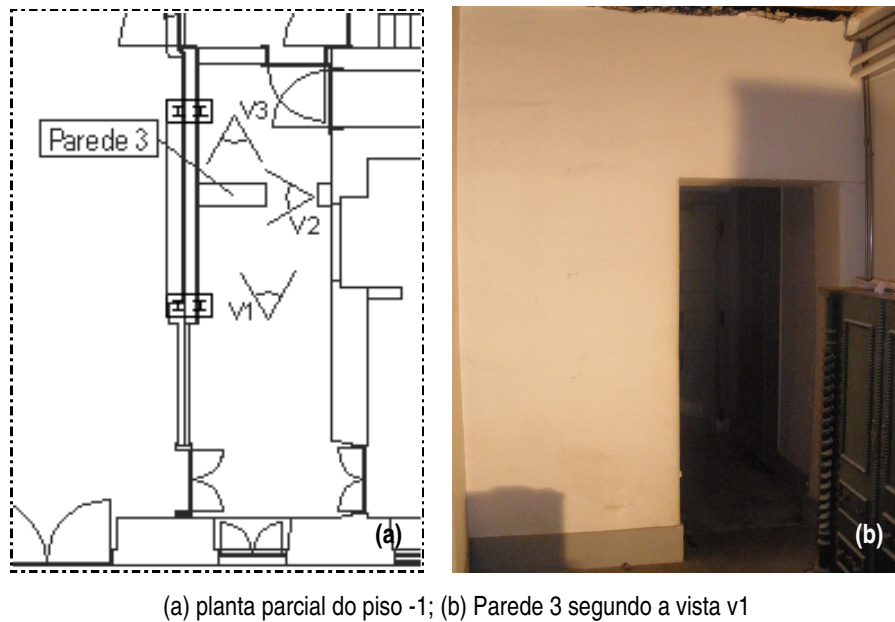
Planta parcial do piso -1 e imagem da vista v1 da Parede 3
